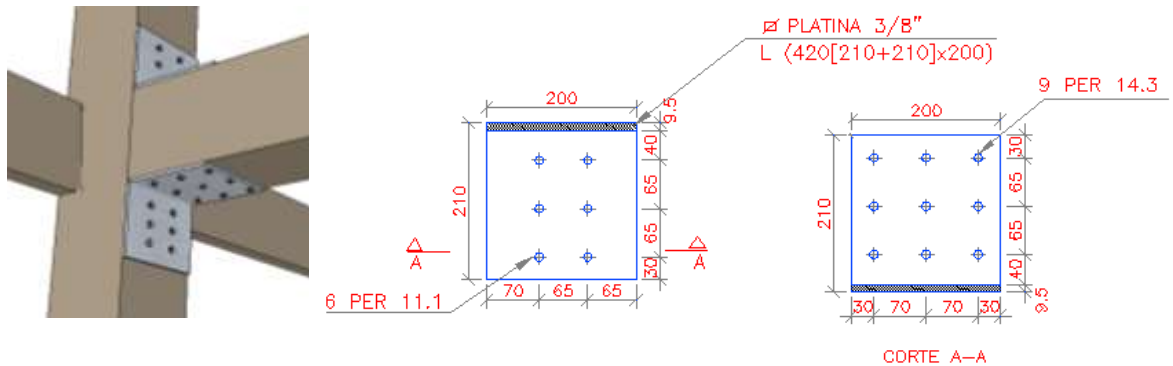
Platina usada para conectar el elemento viga de la conexión P2-T2
